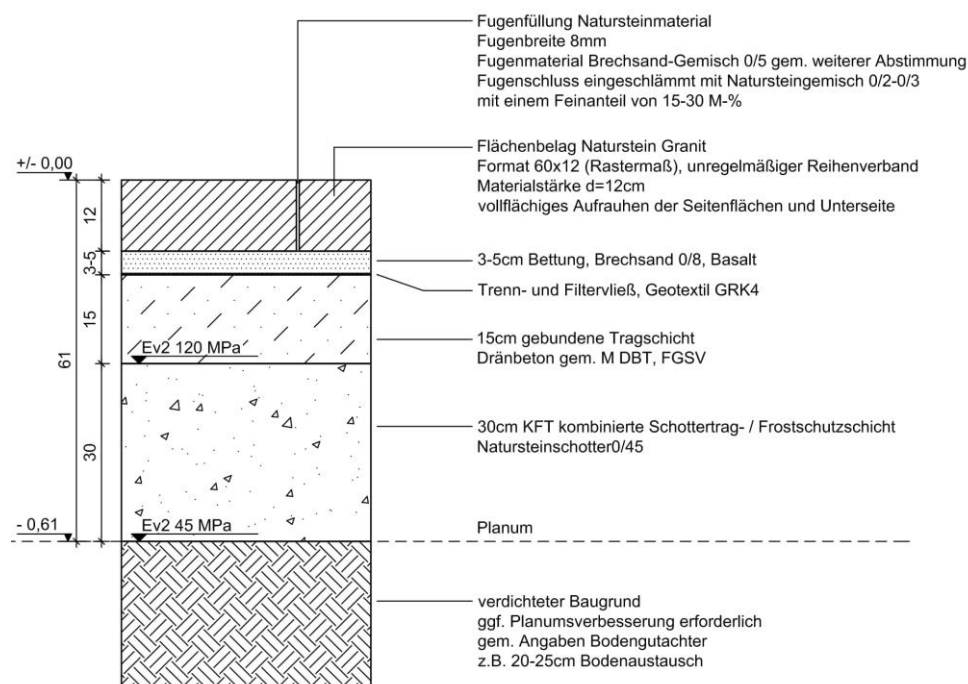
Detail Flächenbelag Naturstein Granit auf Dränbeton
